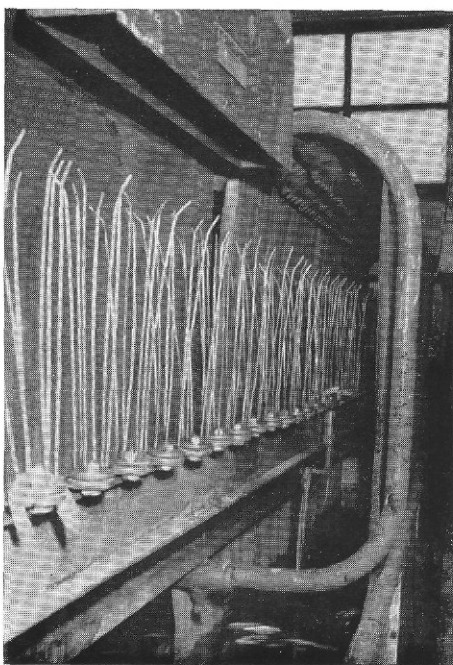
Detail van de douchepijpen en de ventilator-mond.
